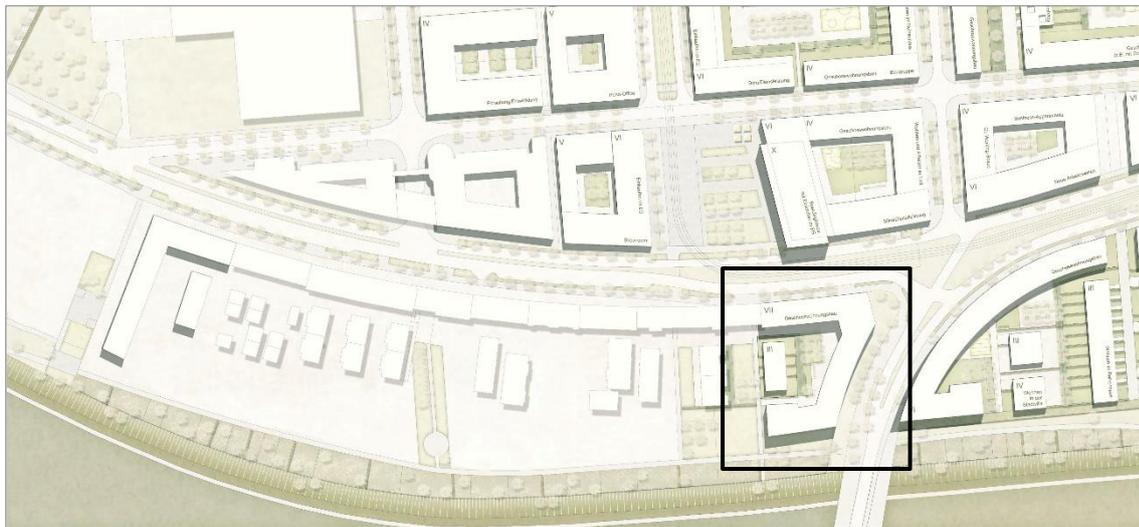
Masterplan (Werkstattverfahrens 2012) mit Markierung des Bebauungsplangebietes
